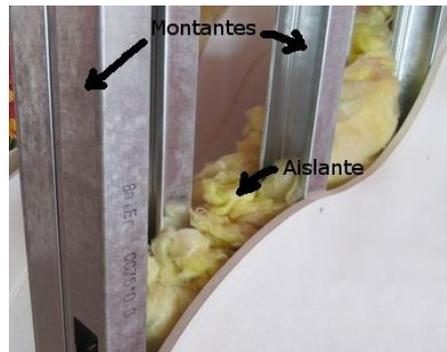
Colocación de placas MDF con aislante (Elaboración propia)
